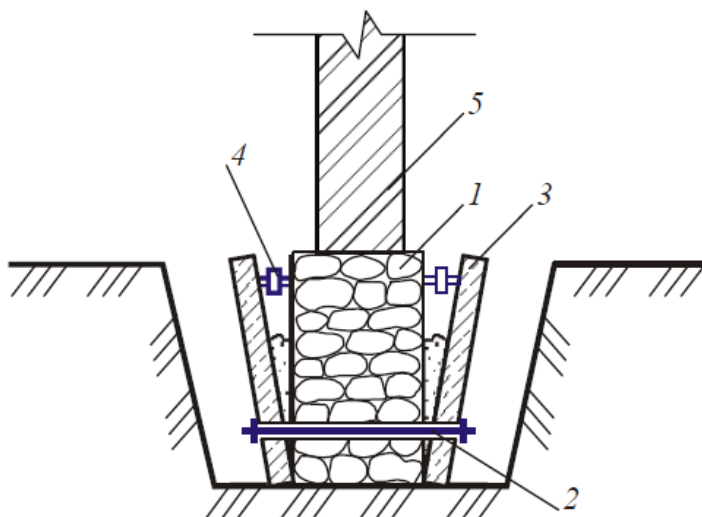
Увеличение площади опирания фундаментов с помощью железобетонных отливов: 1-фундаментов; 2-стальной тяж; 3-железобетонный отлив; 4-домкрат; 5-стена
